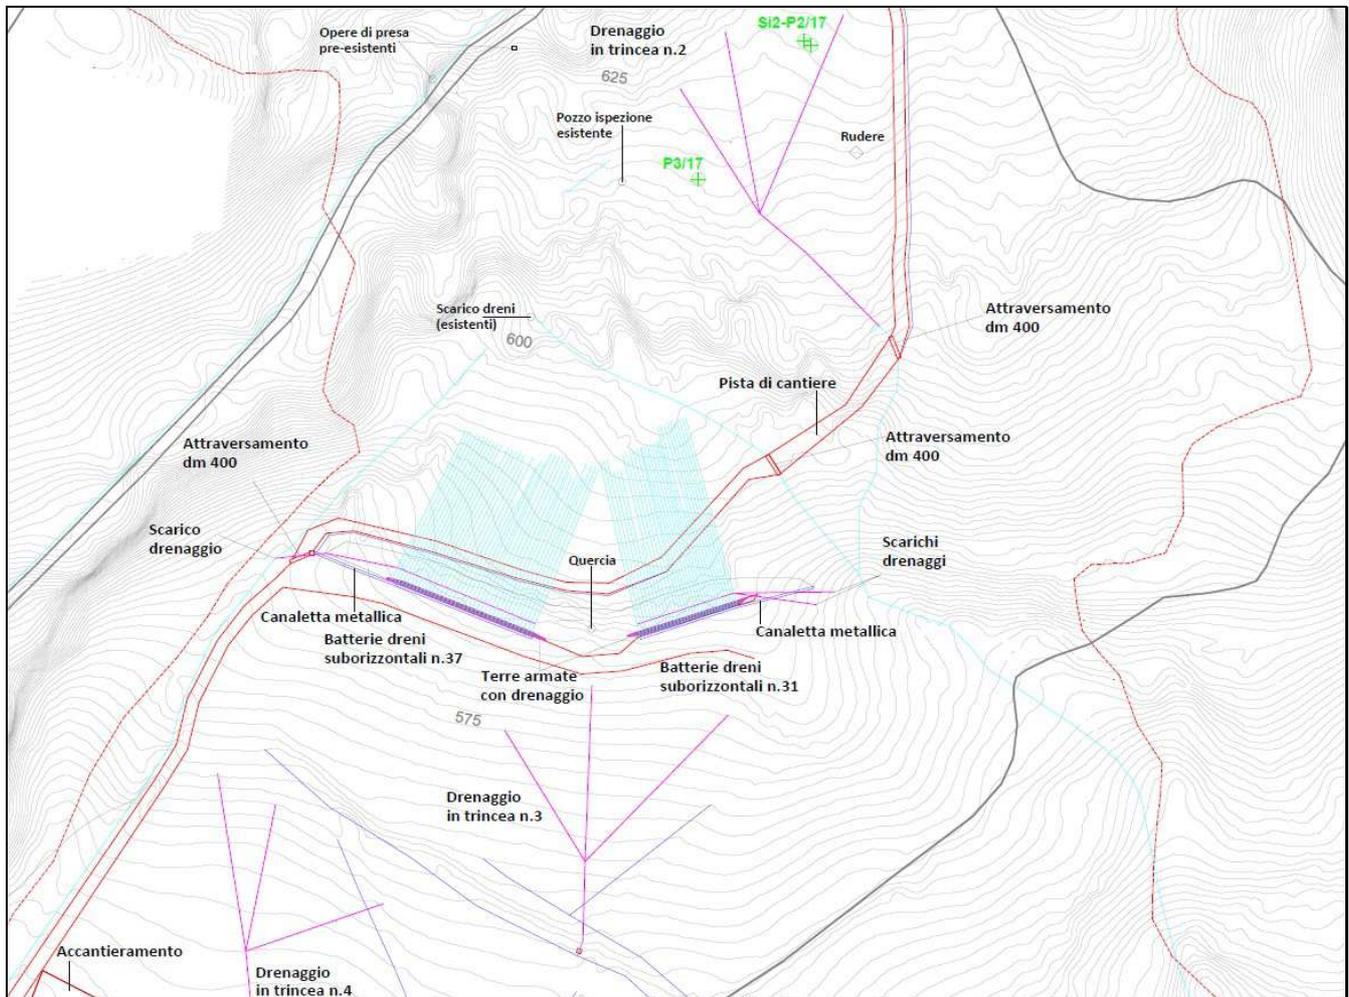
Estratto planimetrico opere eseguite (parte mediana)
